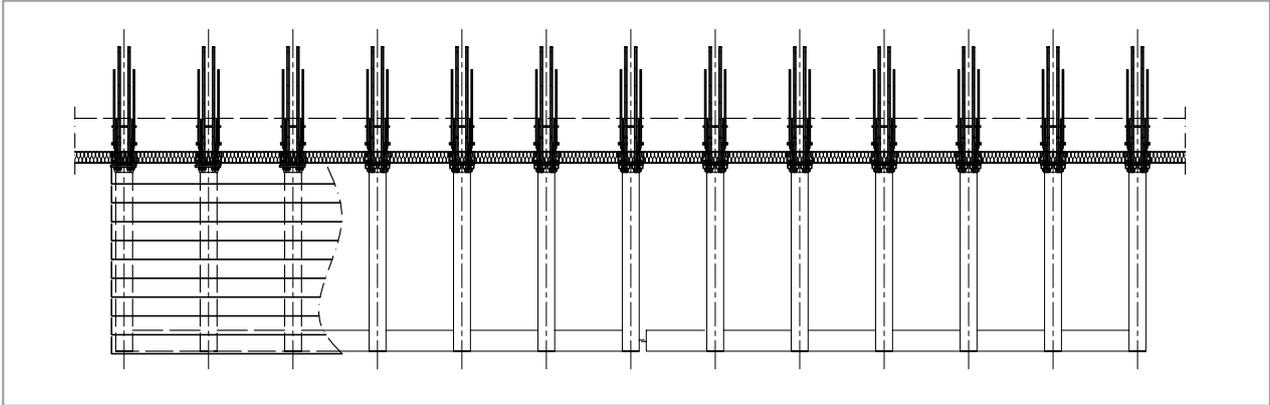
Schöck Isokorb® T tipo SK: Balcón en voladizo
